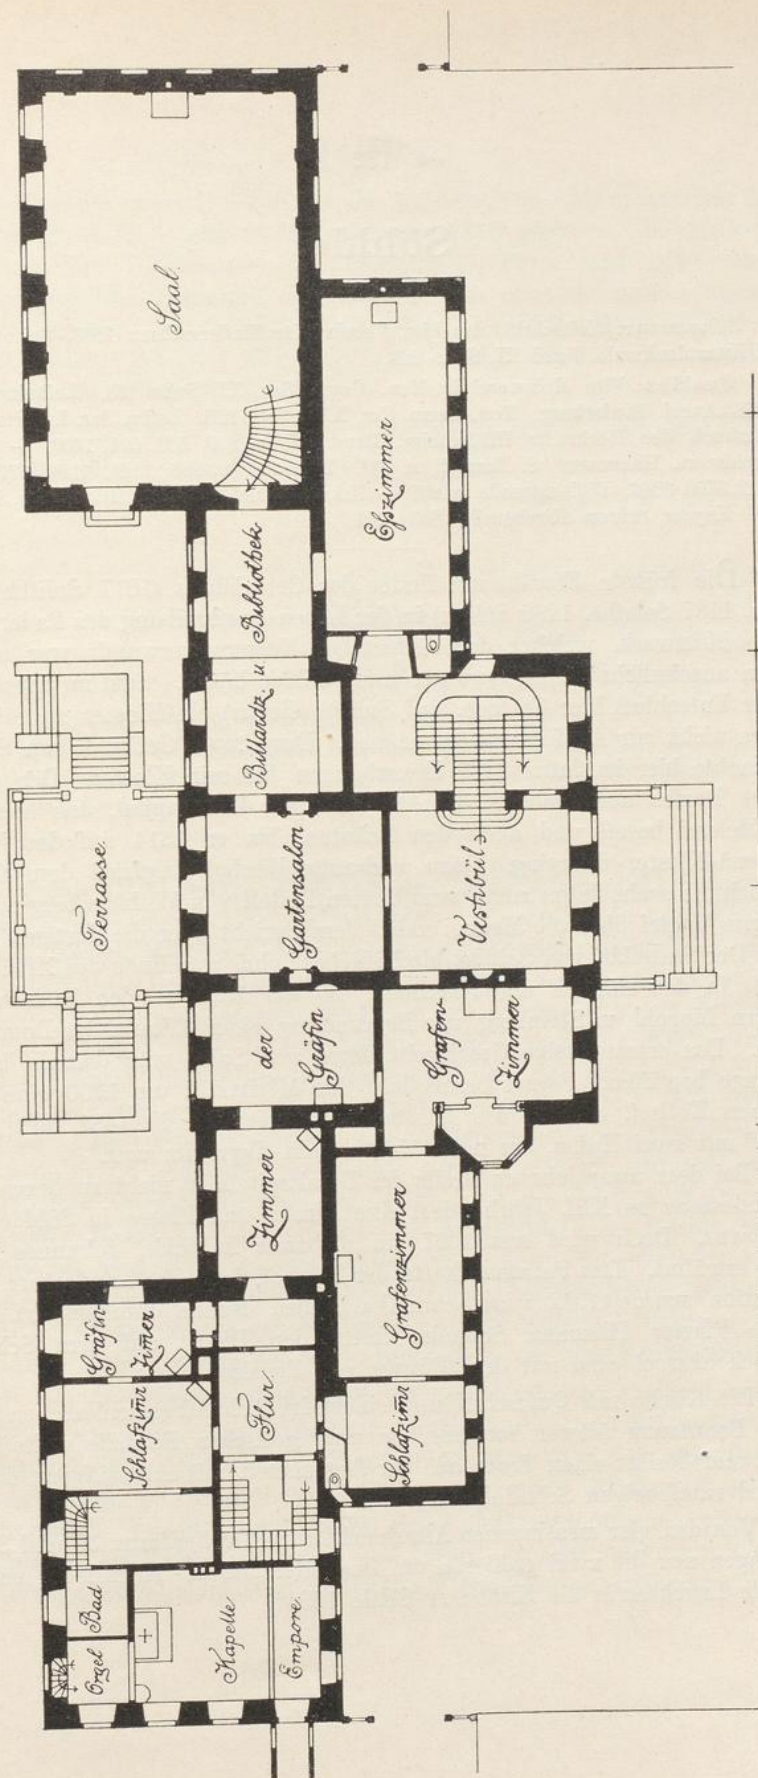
Schloß Süder Erdgeschoßgrundriß des Herrenhauses (Maßstab 1:300).
